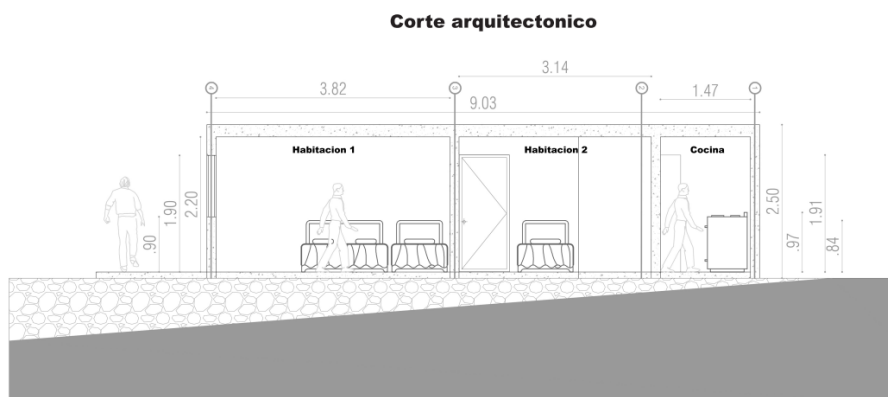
Proyecto vivienda popular, corte arquitectónico. Levantamiento 2015.
